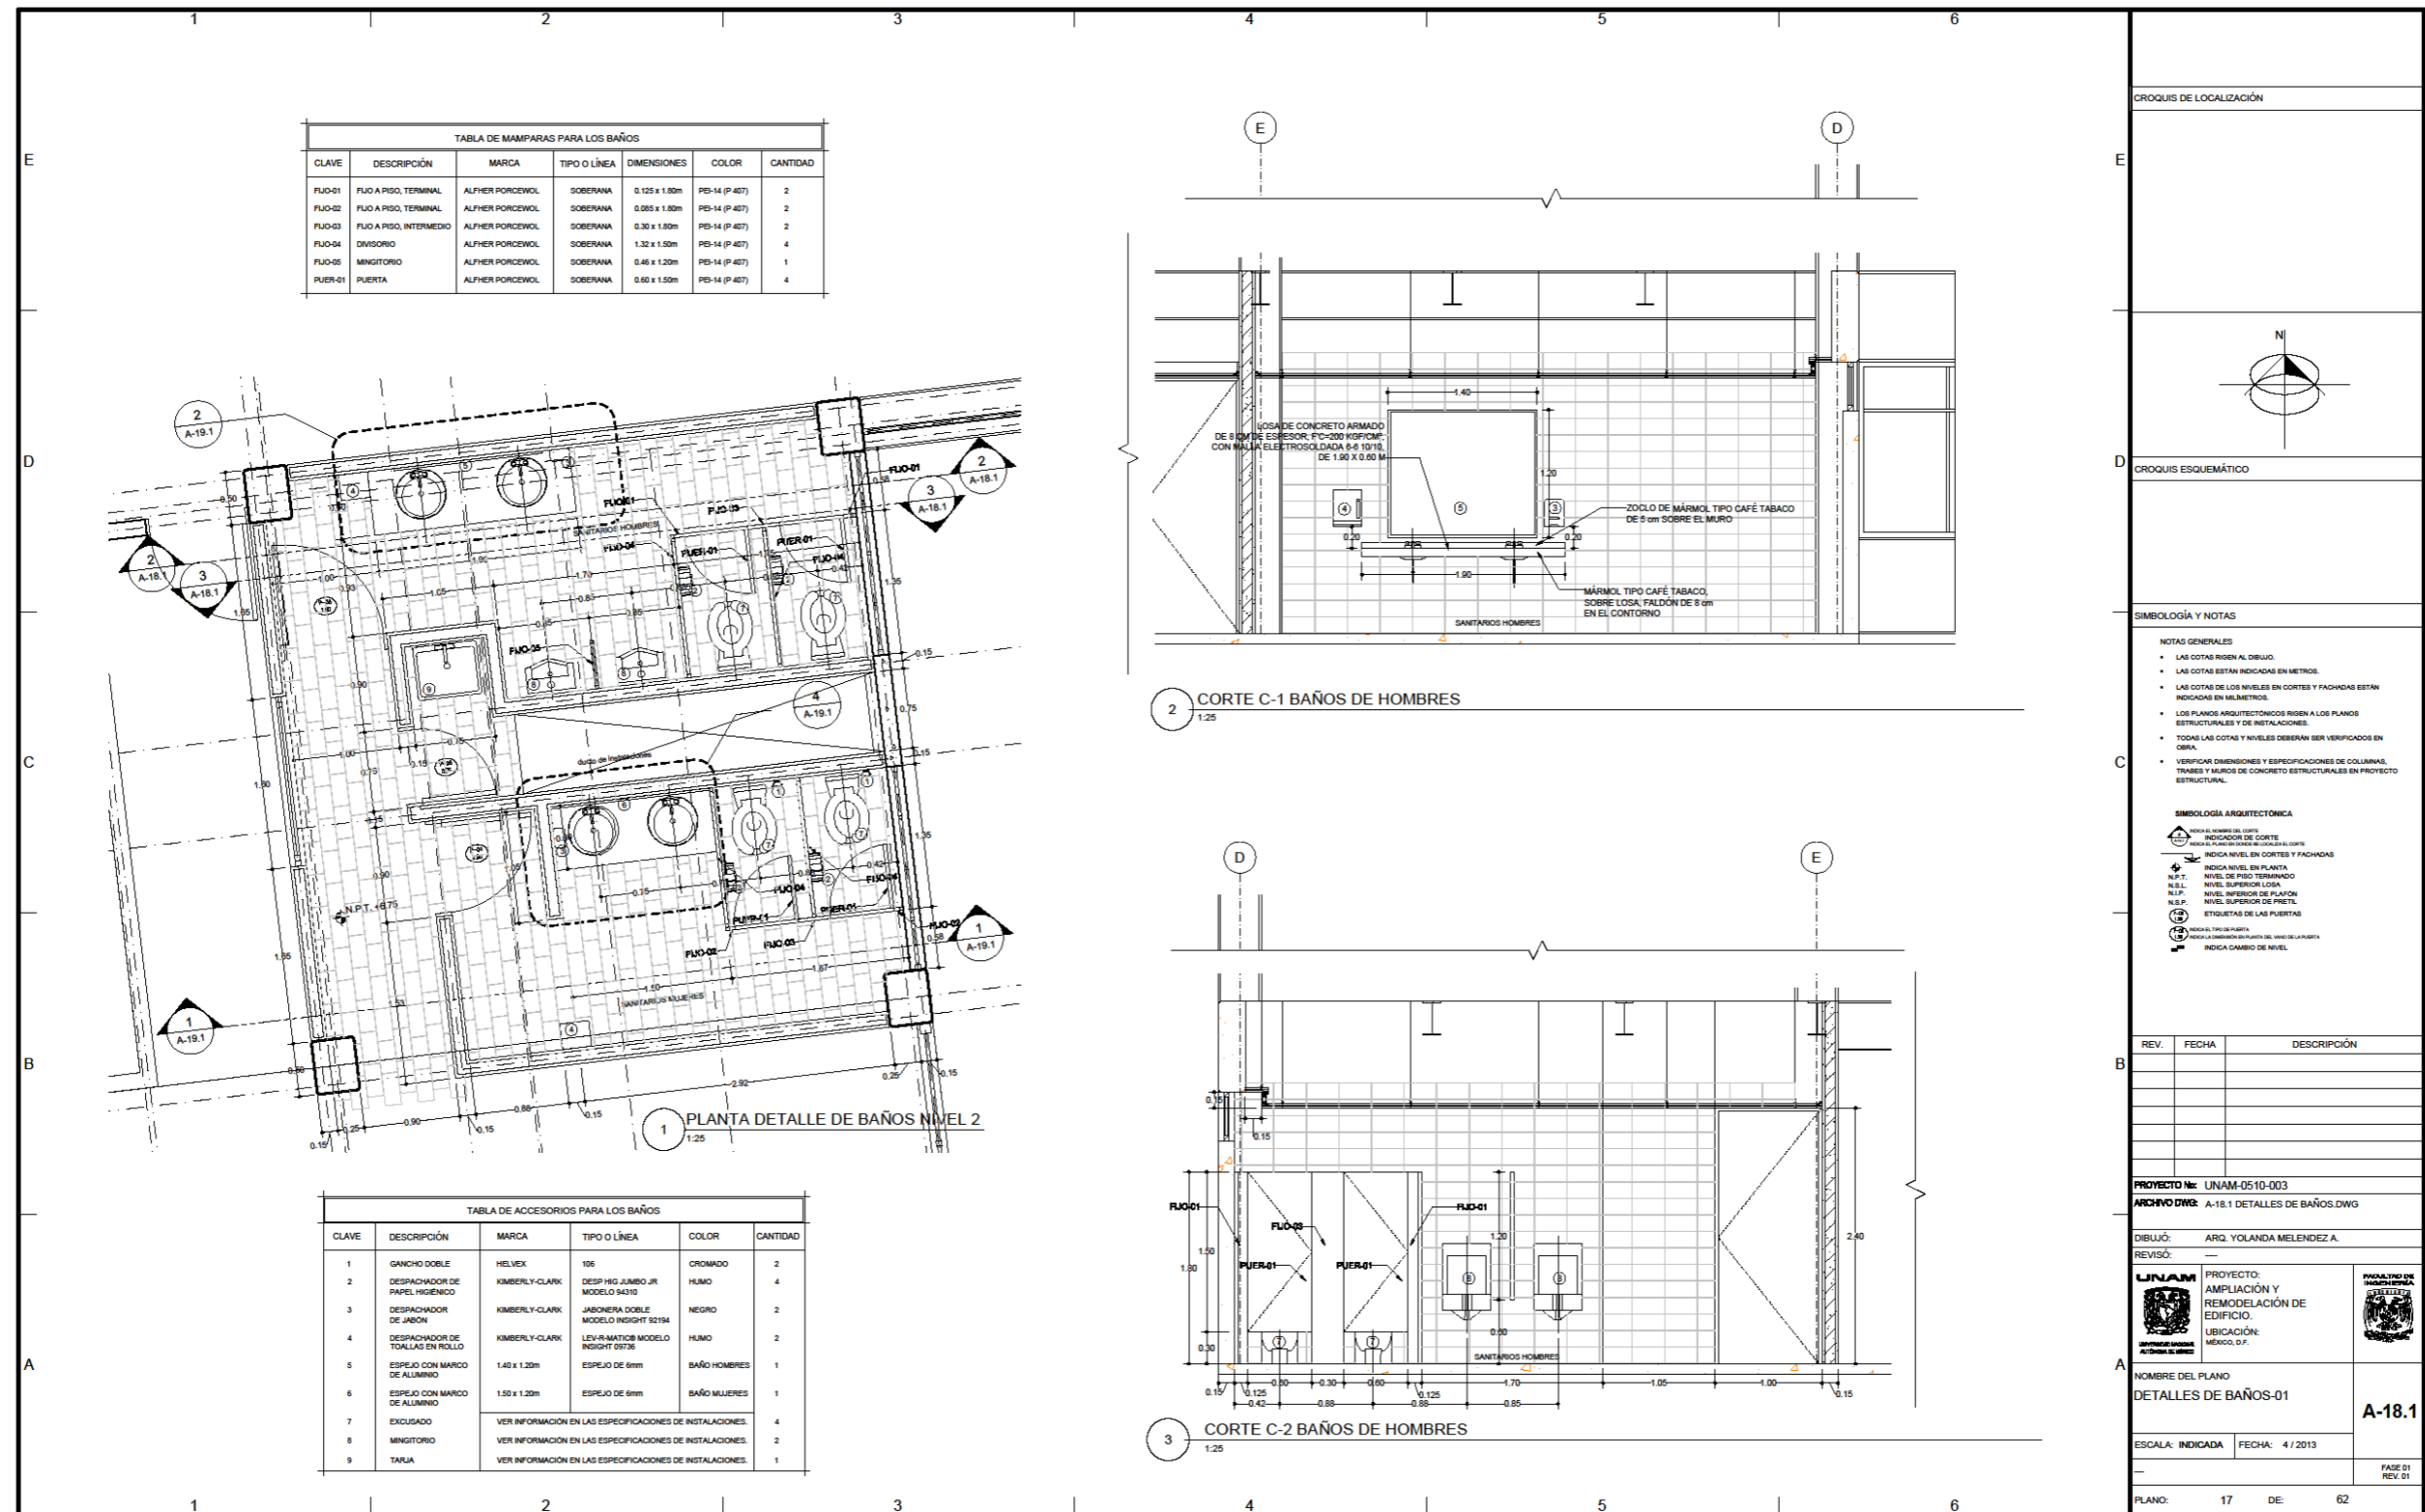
Plano A-18.1 Detalles de los baños 01.
